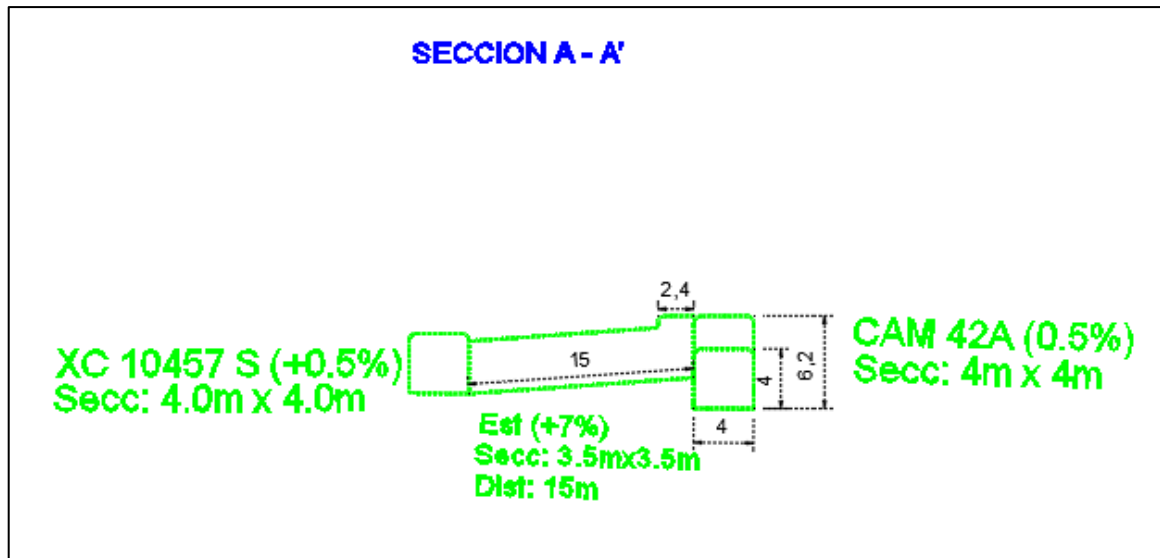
Vista en sección transversal de la cámara de carguío tipo H
